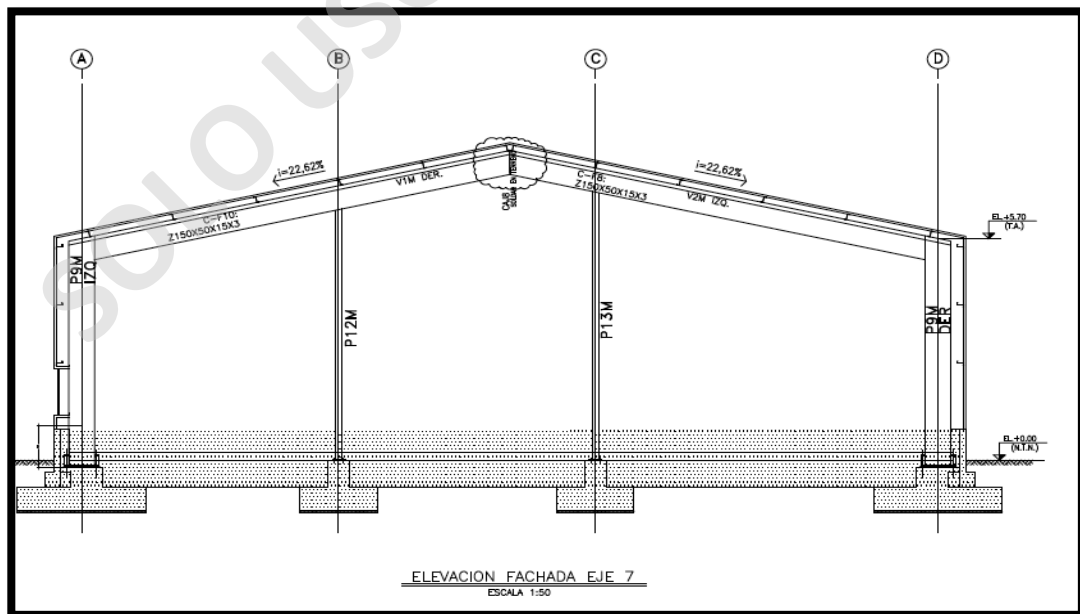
Planos de Montaje ODR Ingeniería y Montajes
